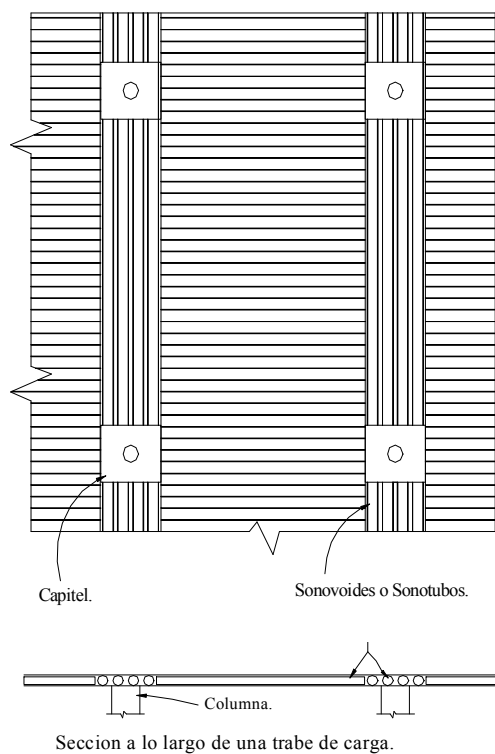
DISPOSICIÓN RECOMENDADA PARA LOS SONOVOIDES EN UNA LOSA PLANA
